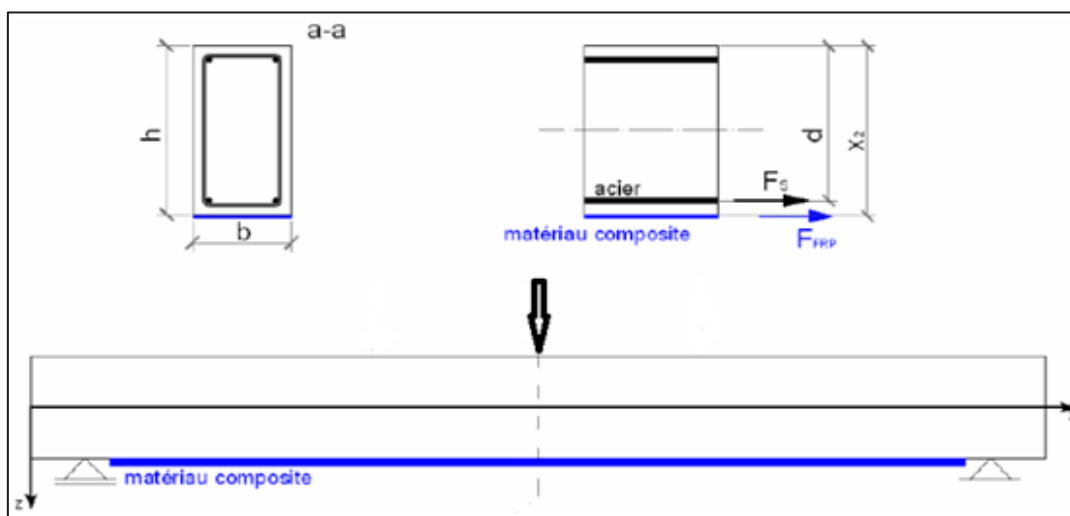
Configuration d'une poutre en béton armé renforcée soumise à la flexion trois points.
